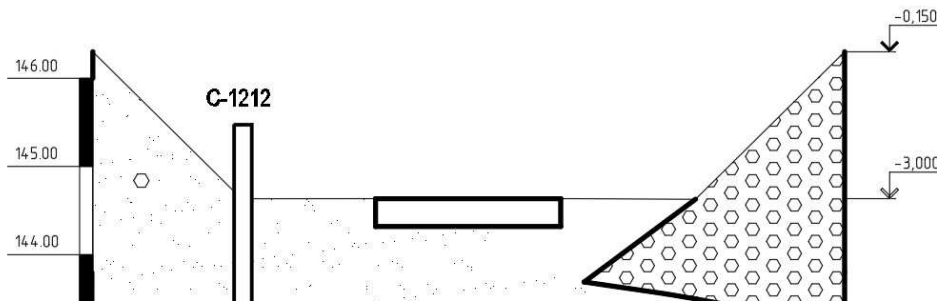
Инженерно-геологический разрез плитного фундамента
